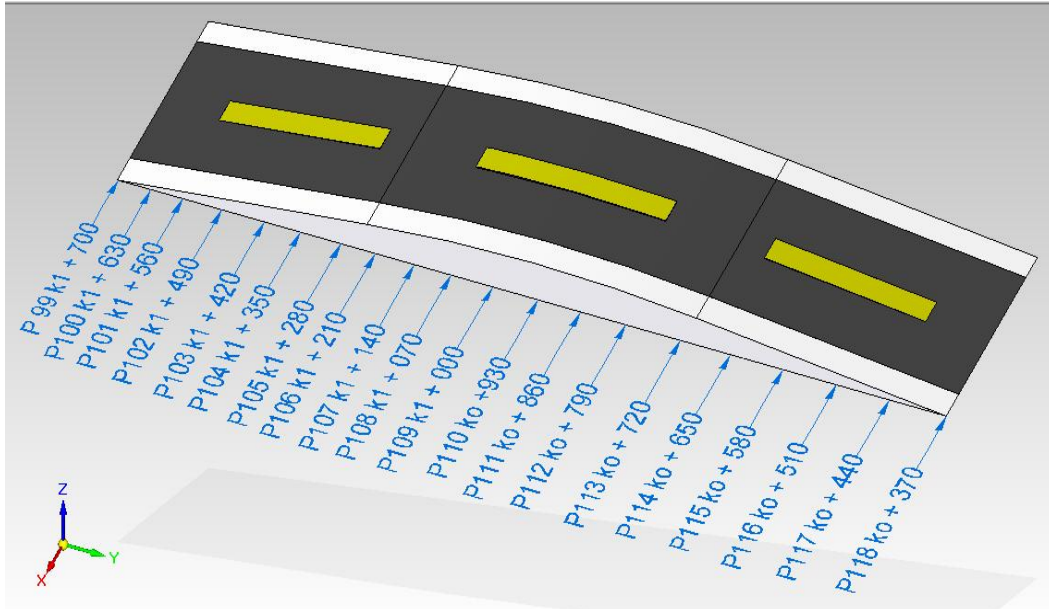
Calzada nueva vía La Paila – Zarzal (Valle)
